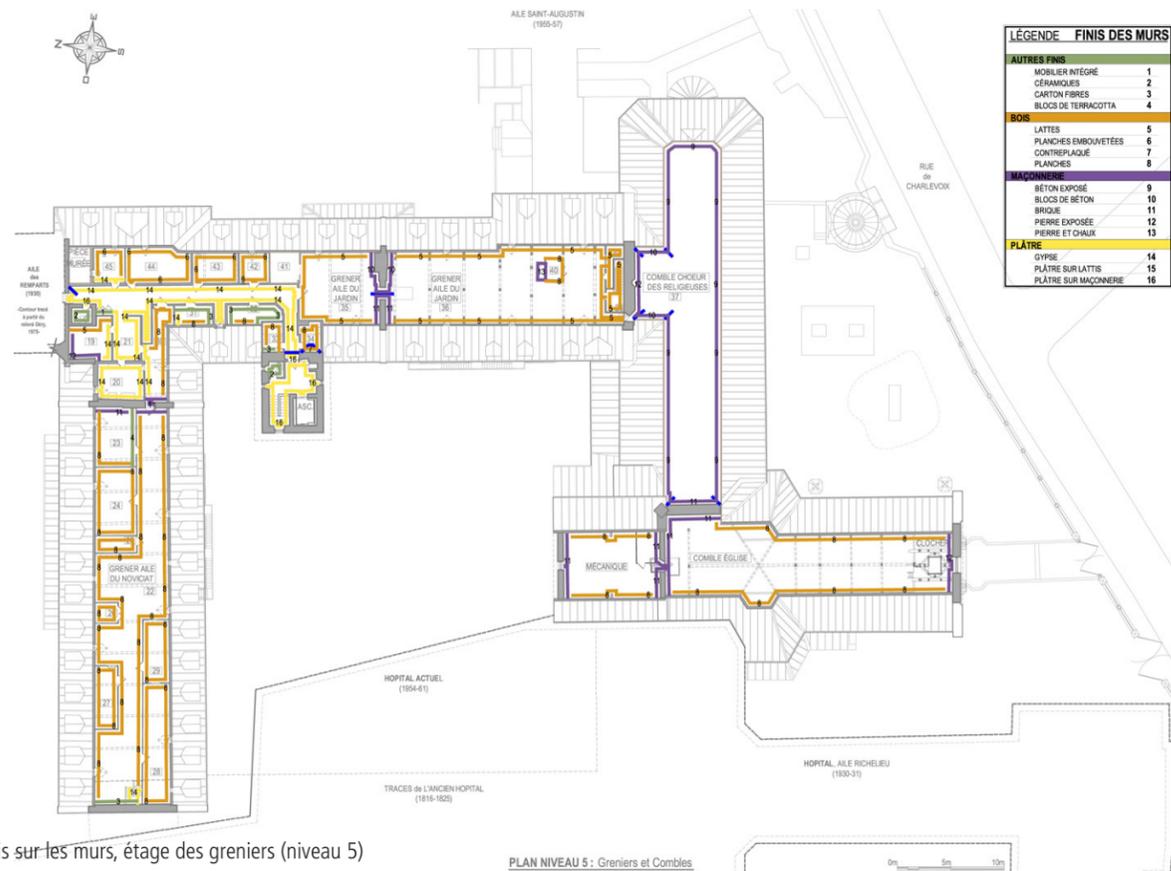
Plan des finis sur les murs, étage des greniers (niveau 5)
